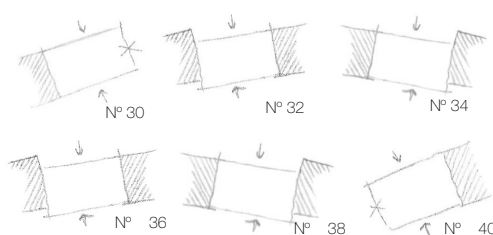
Bocetos en planta de las construcciones situadas en la Avenida Castelao-Coia, nº 30, 32, 34, 36, 38 y 40 (autoría propia).
